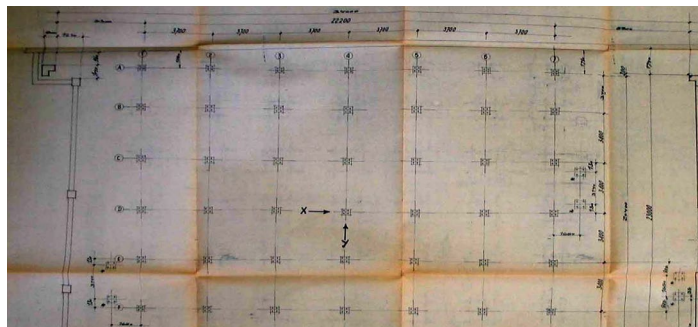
Pianta posizionamento fondazioni nella sezione d'Arte, 1984 \_ Archivio Ufficio Tecnico \_ Università degli Studi di Parma
